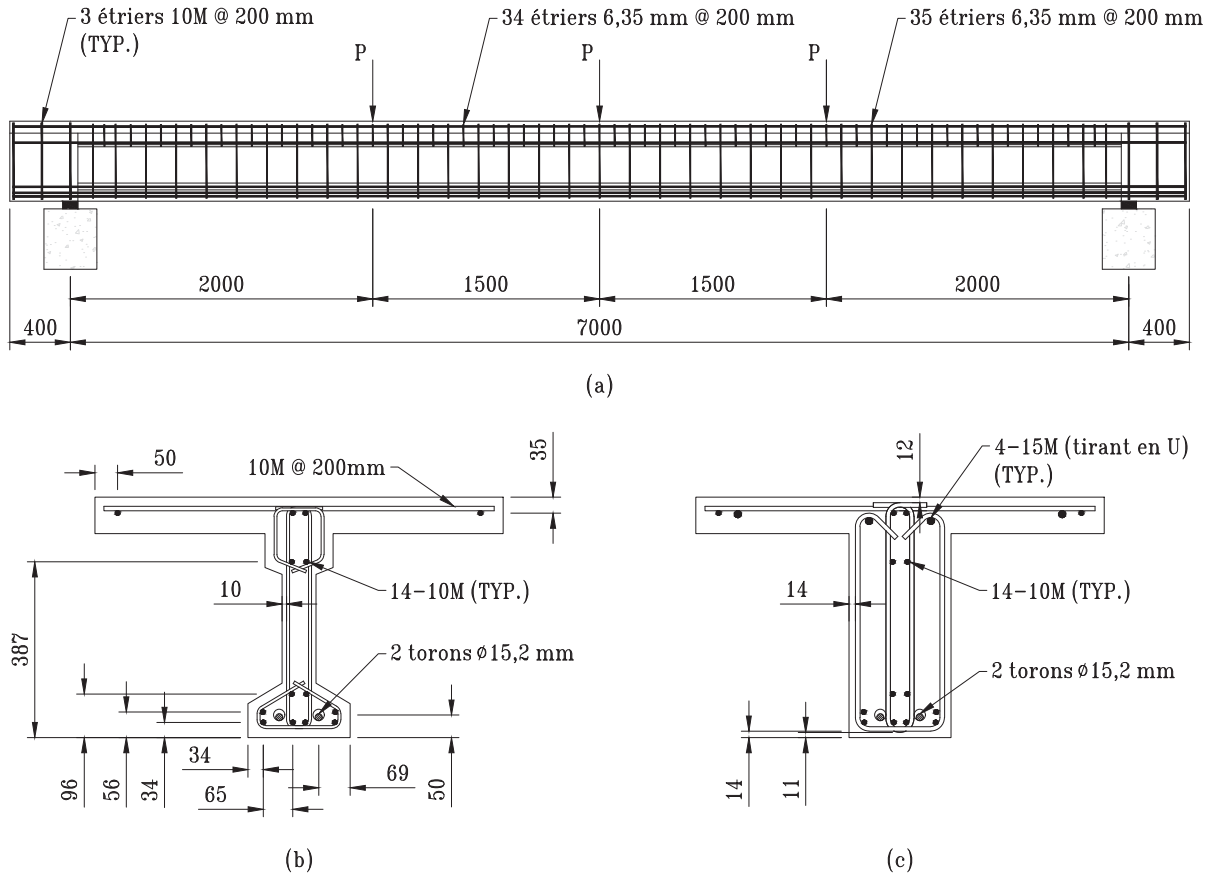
Ferrailage des poutres : (a) vue en élévation, (b) section en portée et (c) section aux appuis
